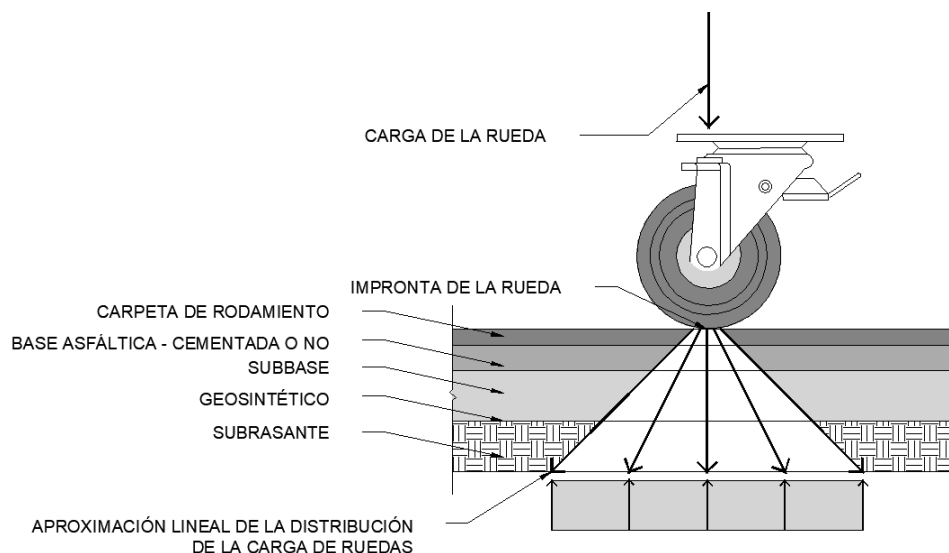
Distribución de carga de una rueda en el pavimento flexible
